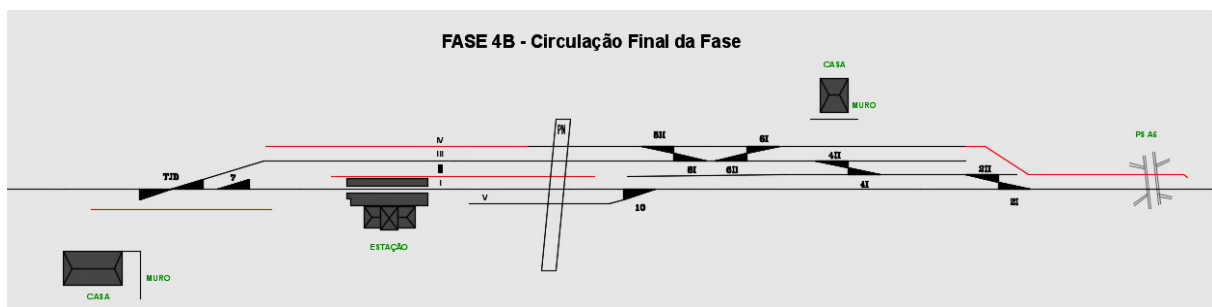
Fase 4B – Levantamento dos restantes tramos de via provisória e restante linha II
